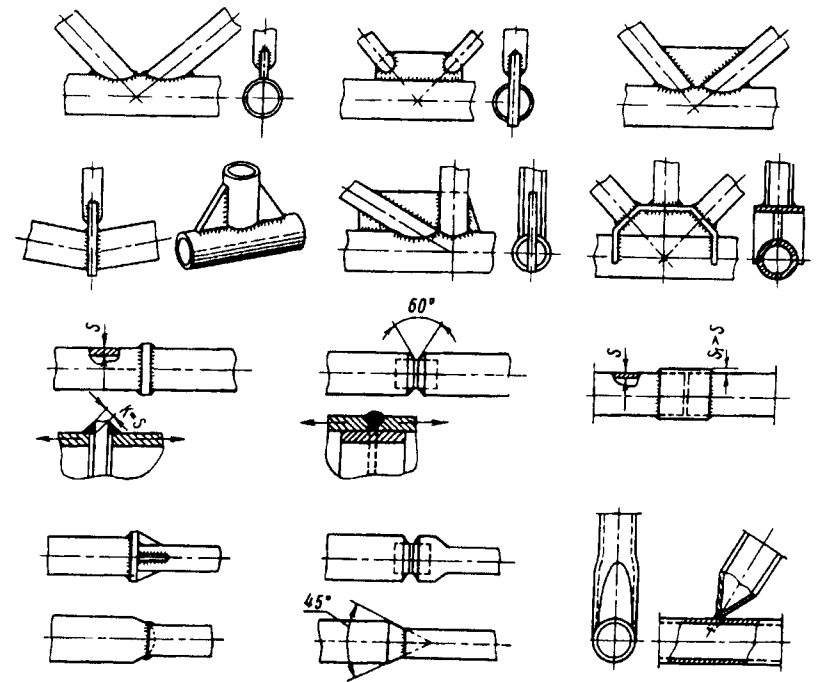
Оформление узлов ферм с трубчатыми стержнями и сварных стыков труб
